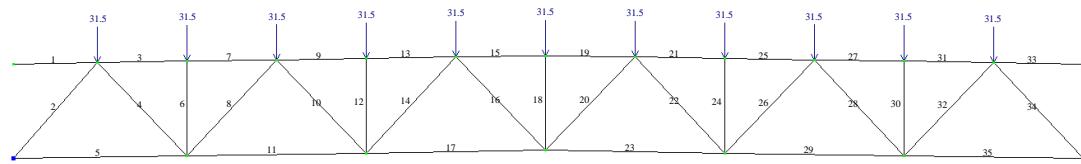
Снеговая нагрузка на всем пролете фермы (Загружение №2)
